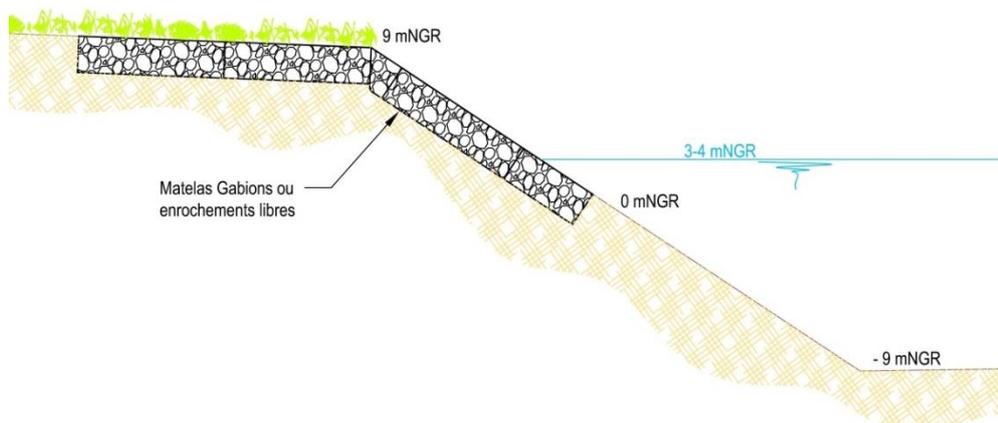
Coupe longitudinale type de l'ouvrage en entrée et en sortie de la fosse d'extraction
